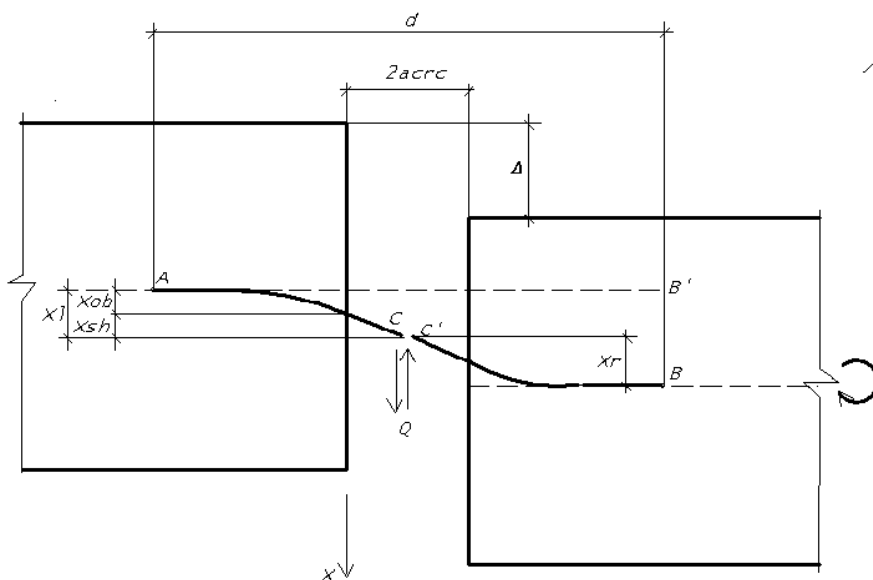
Схема деформирования арматуры и взаимного поворота блоков
